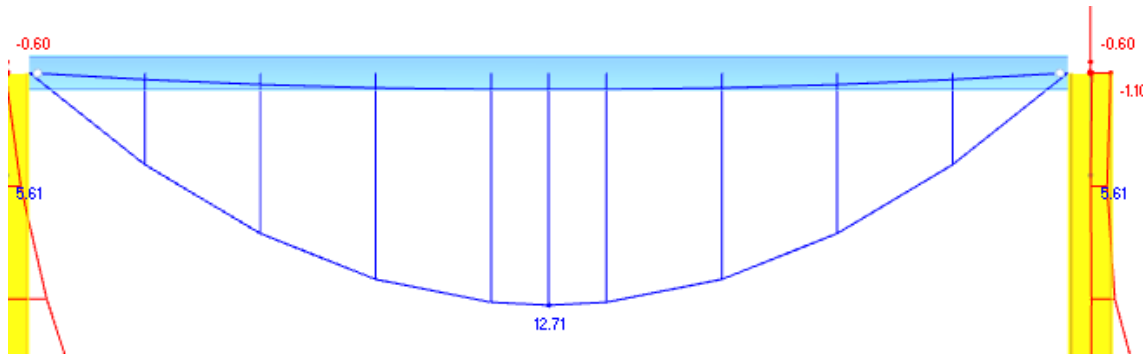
Módulo sin arriostrar de base rígida y unión viga pilar simple.
